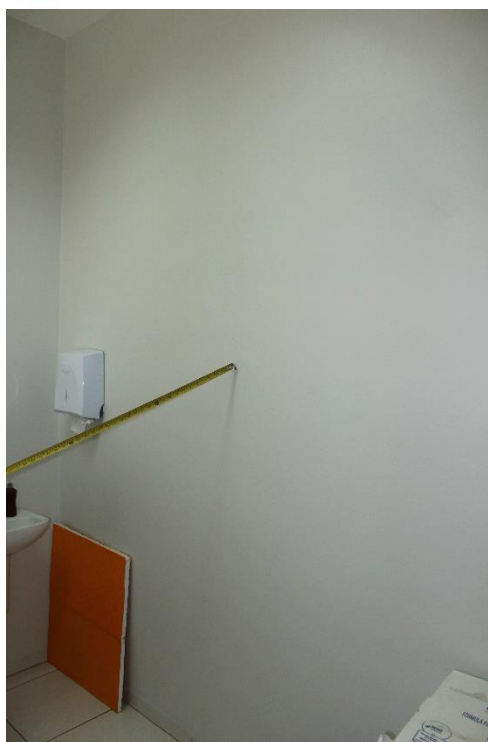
Vista parcial da sala 51, destacando fissura diagonal em alvenaria.
